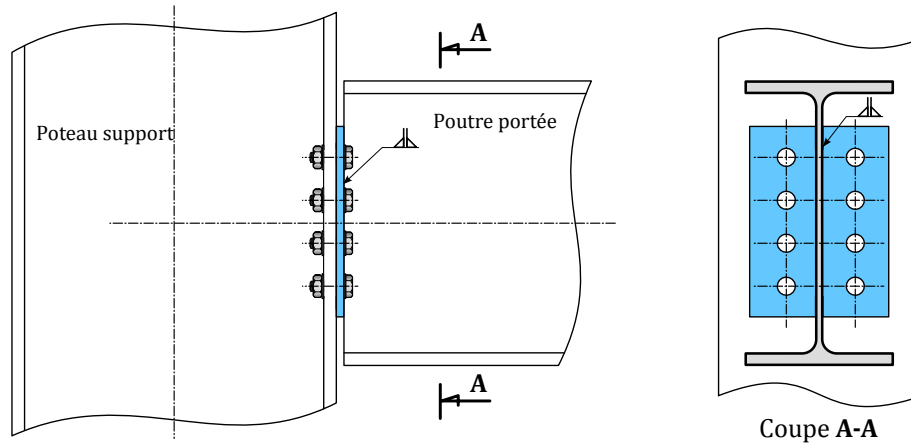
Assemblage d'une poutre par platine d'about réduite
